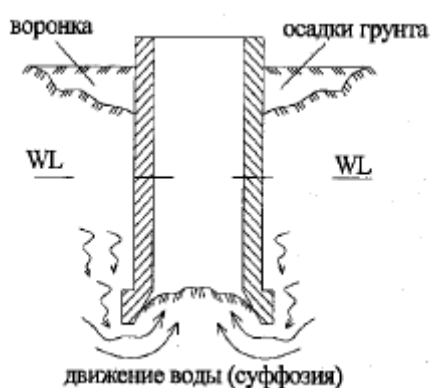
Схема движения воды (суффозии) при выемке грунта из опускного колодца
